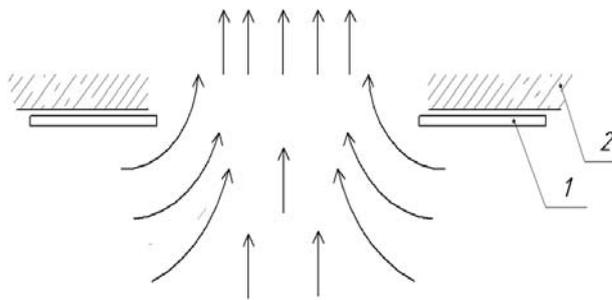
Принципиальная схема натекания воздуха при открытых откатных воротах: 1 – полотно ворот; 2 – стена здания
